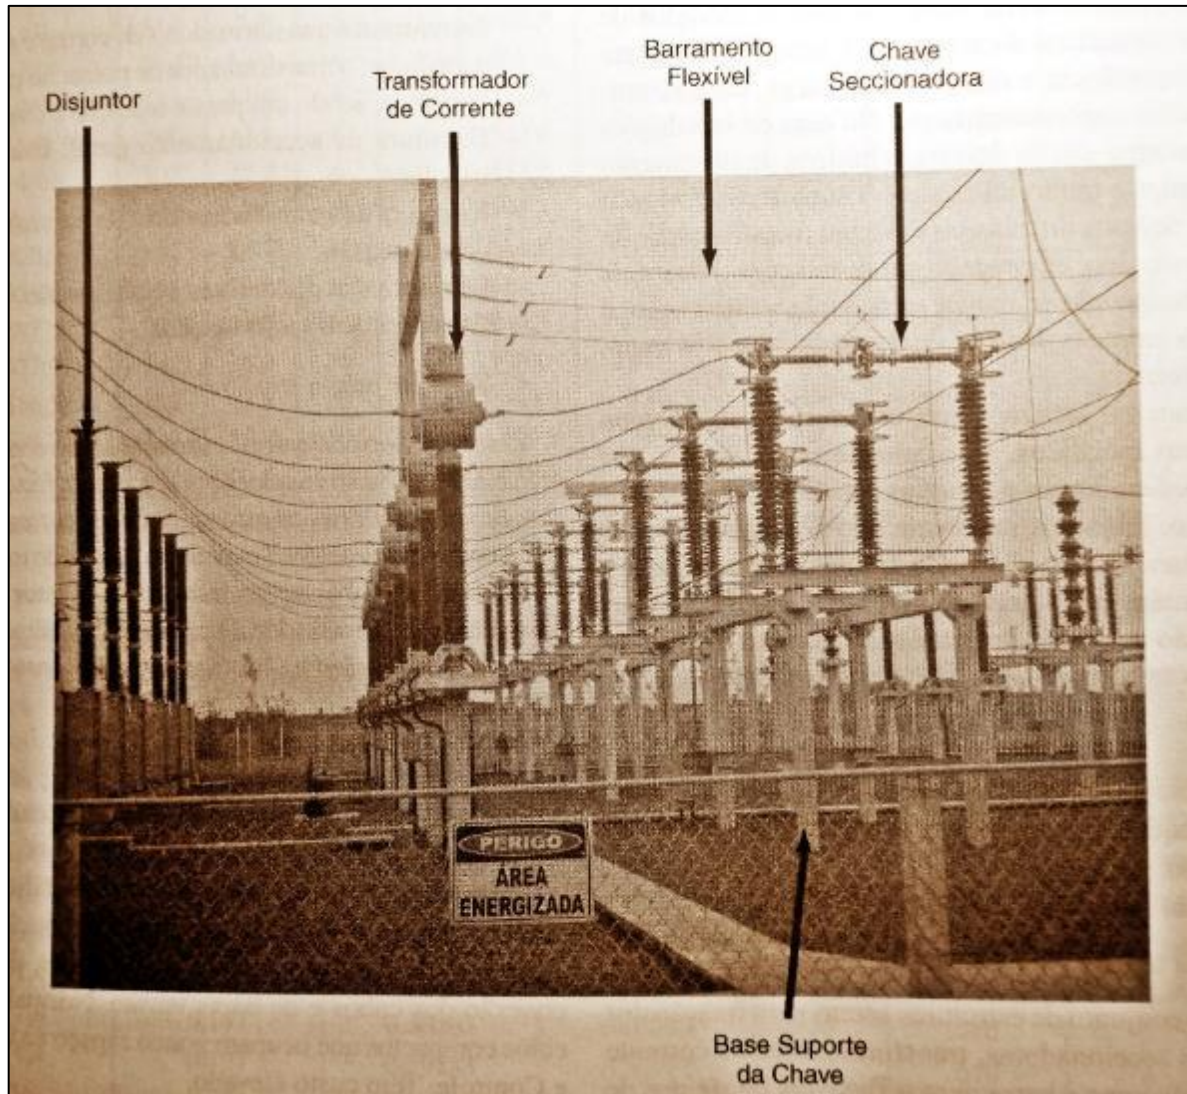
Vista detalhada da montagem de disjuntor, TC e chave seccionadora
